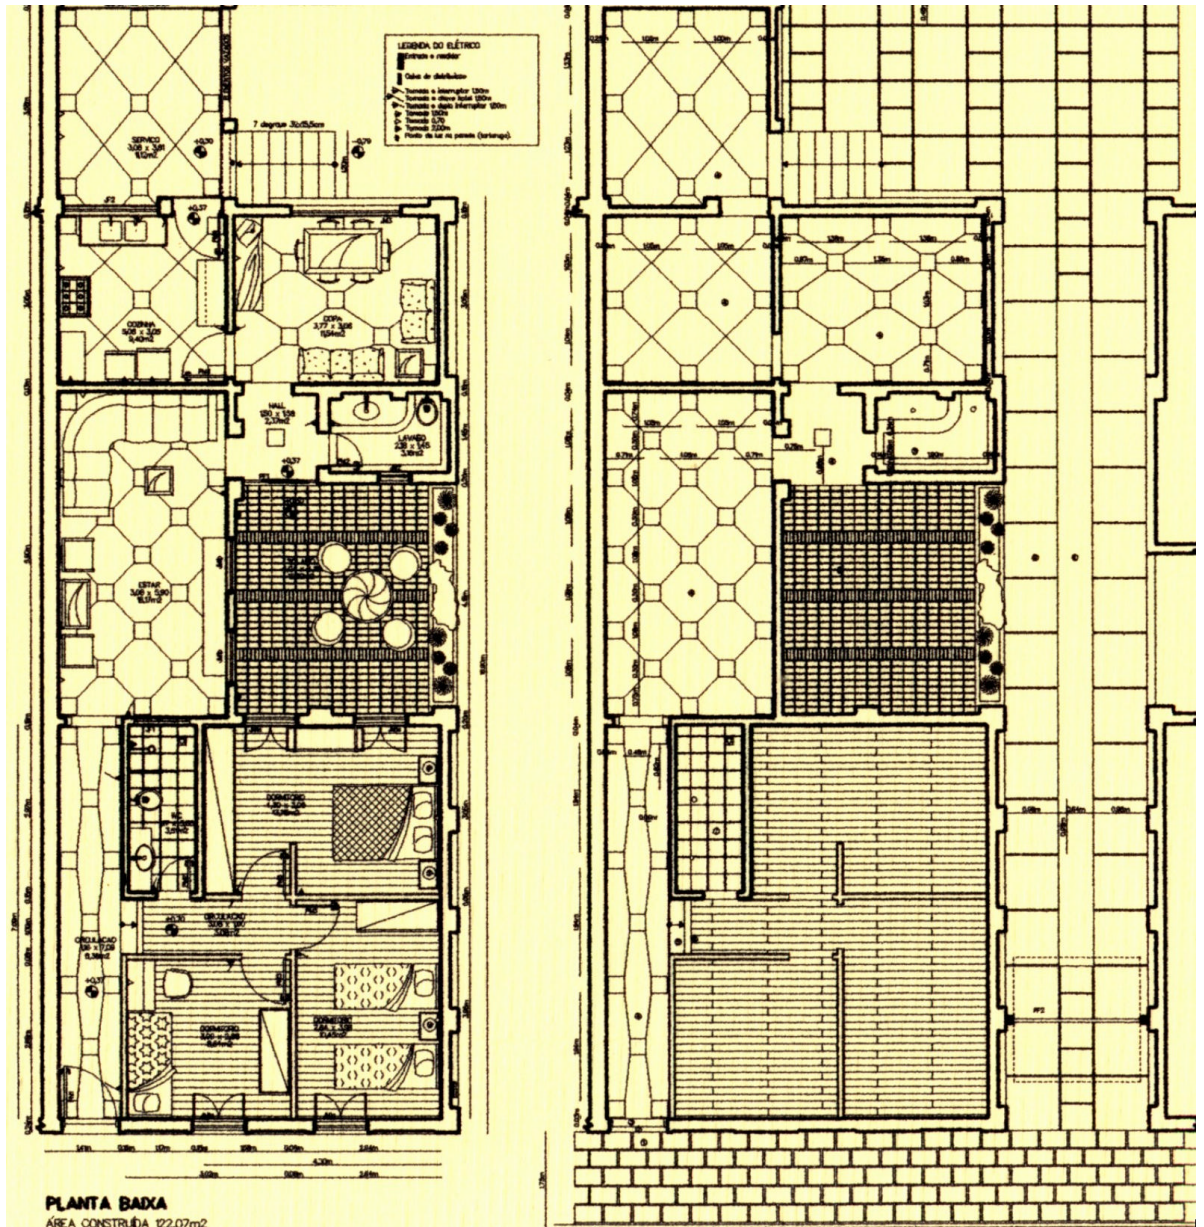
Planta baixa mobiliada e planta baixa. Projeto do autor.
